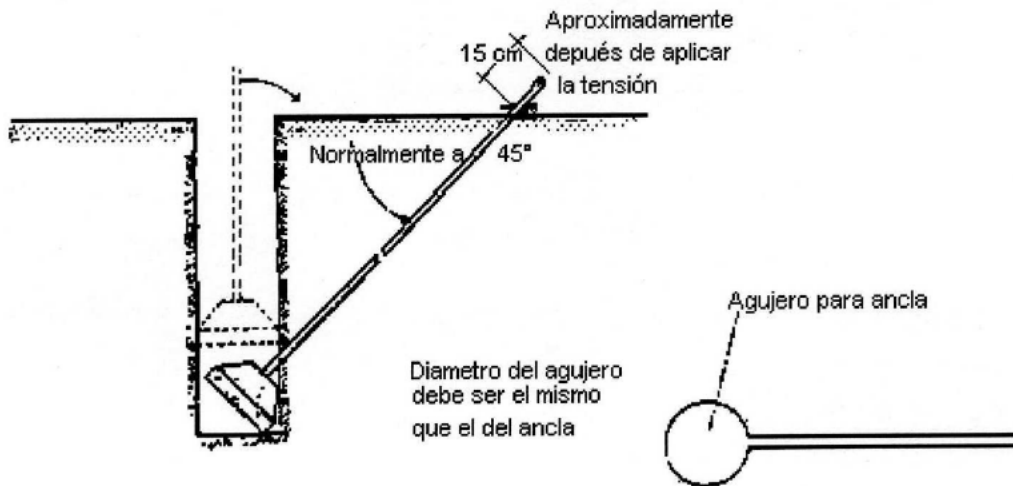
Forma utilizada para el anclaje de estructuras en distribución. Fuente: SIGET
